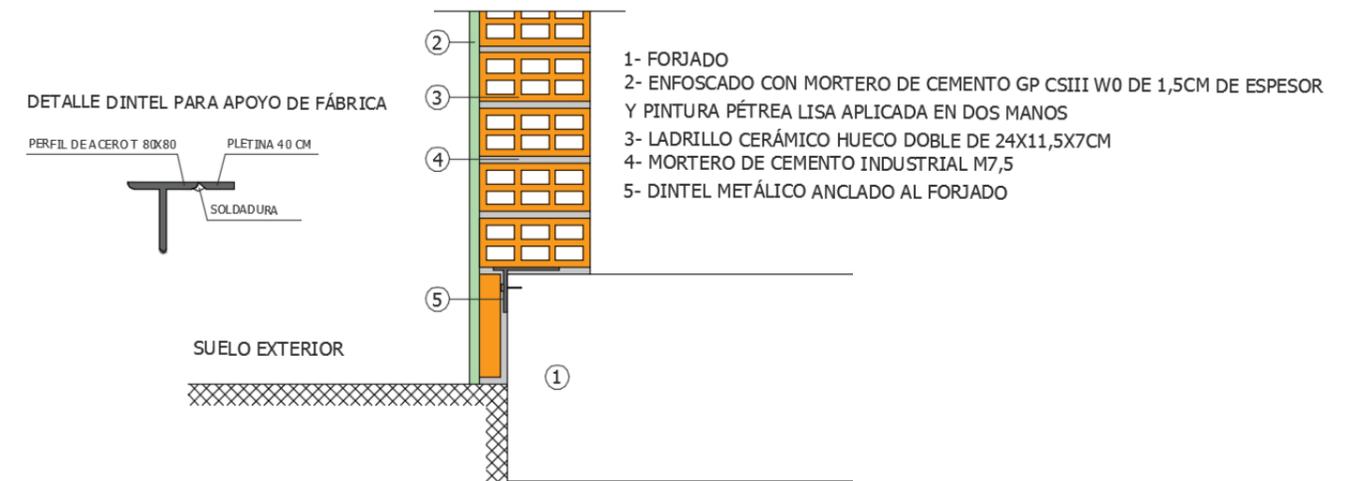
Detalle encuentro de fachada con el forjado. 2018. Elaboración propia
